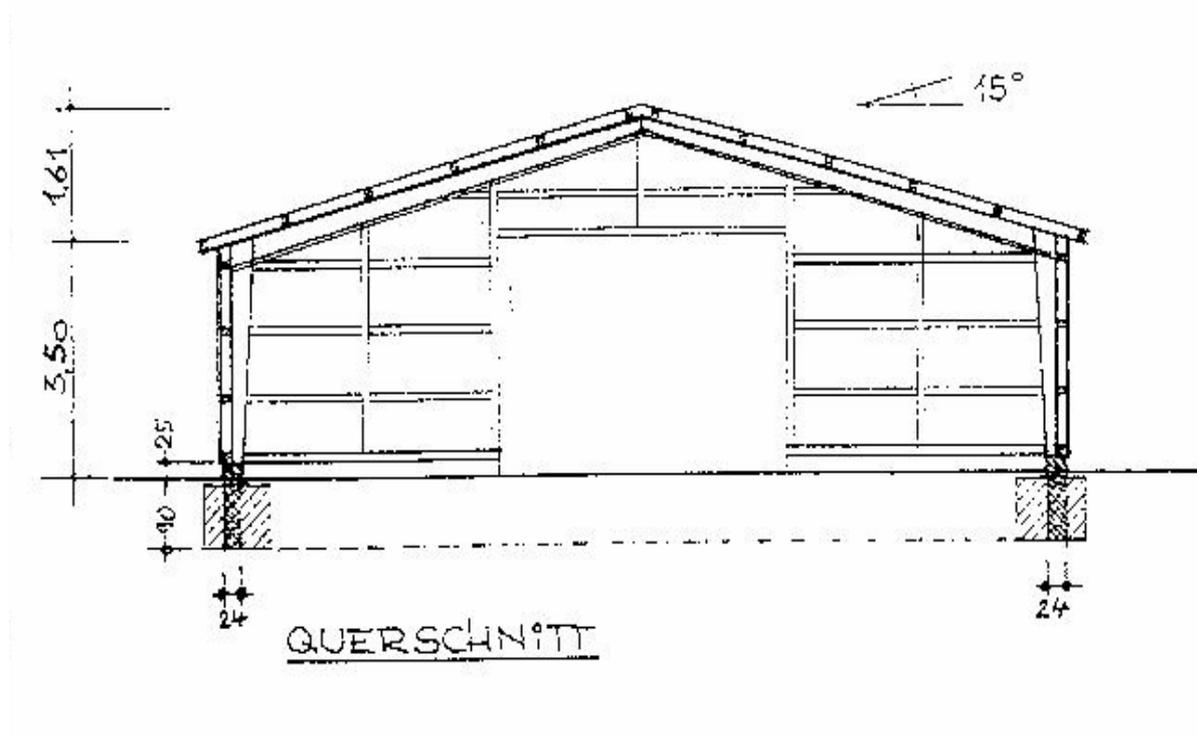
Mehrzweckhalle (Werkbild Kerstenbau)
